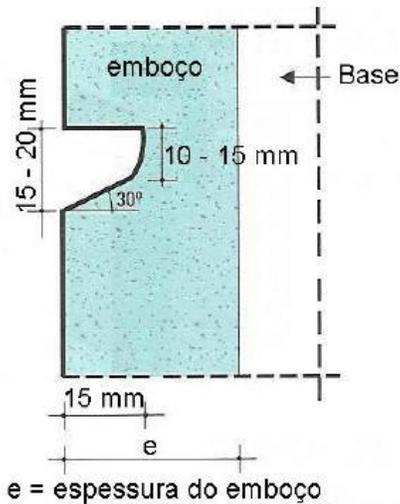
Detalhe construtivo da junta de trabalho.
